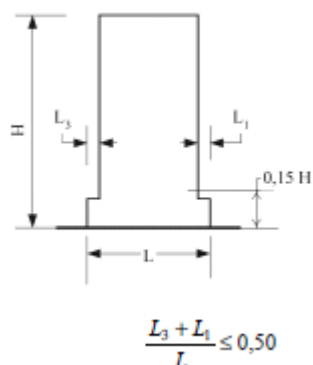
Limitação do recuo a 50% da dimensão em planta do piso inferior.
